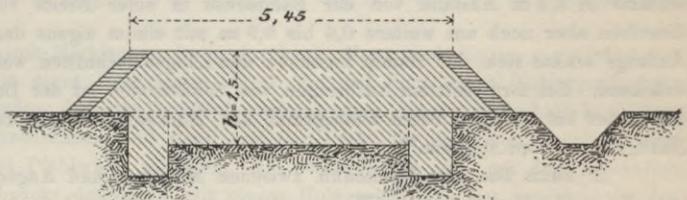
Abtrennen des Dammlagers mit weicher Moordecke.
